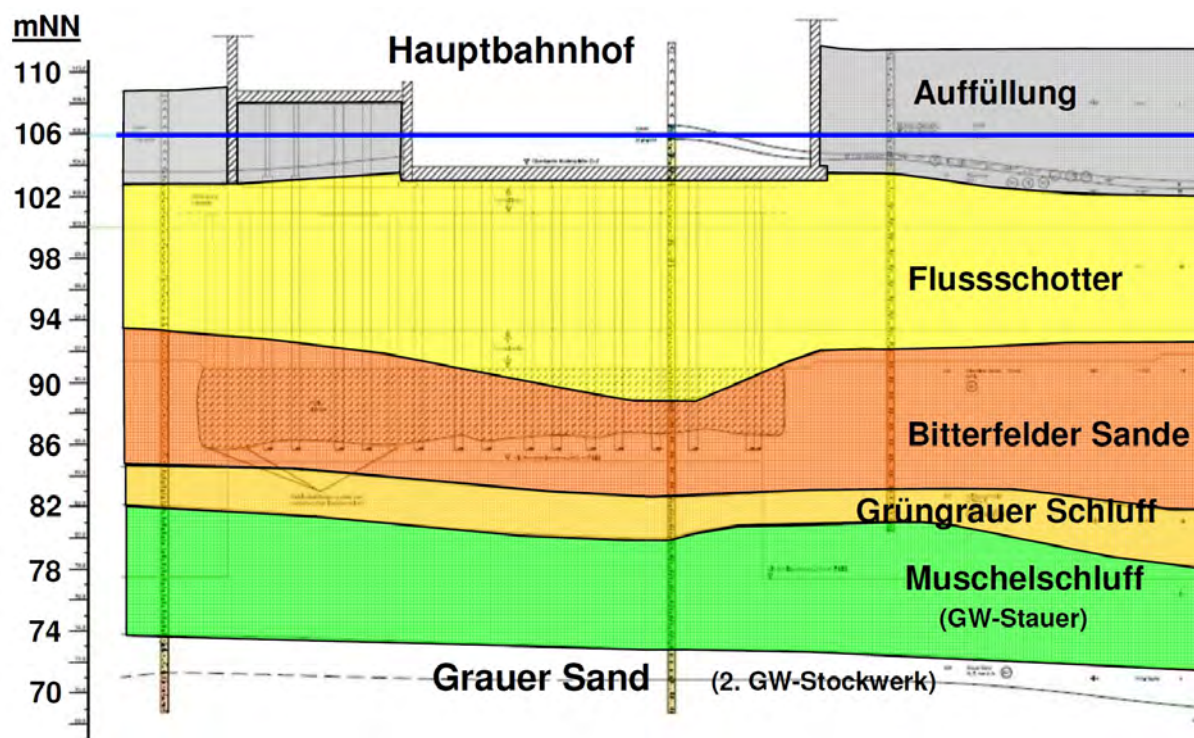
Baugrundaufbau im Tunnelbereich - Längsprofil
